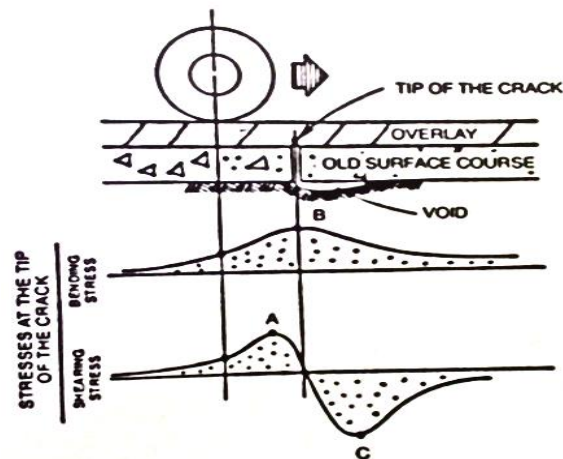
Tensiones desarrolladas en el pavimento fisurado.
